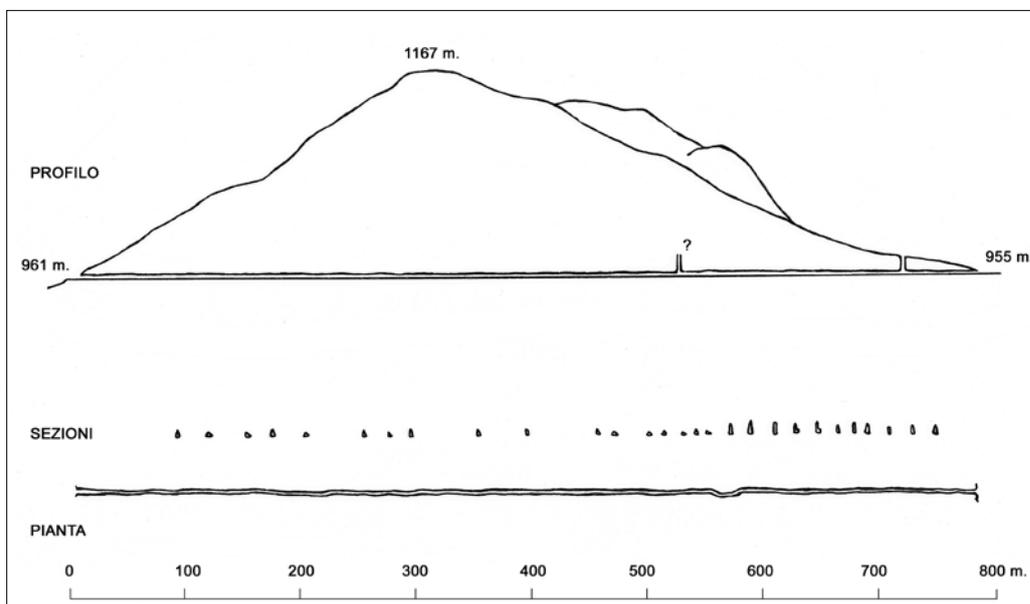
Profilo planimetrico dell'emissario di monte Frontino.
